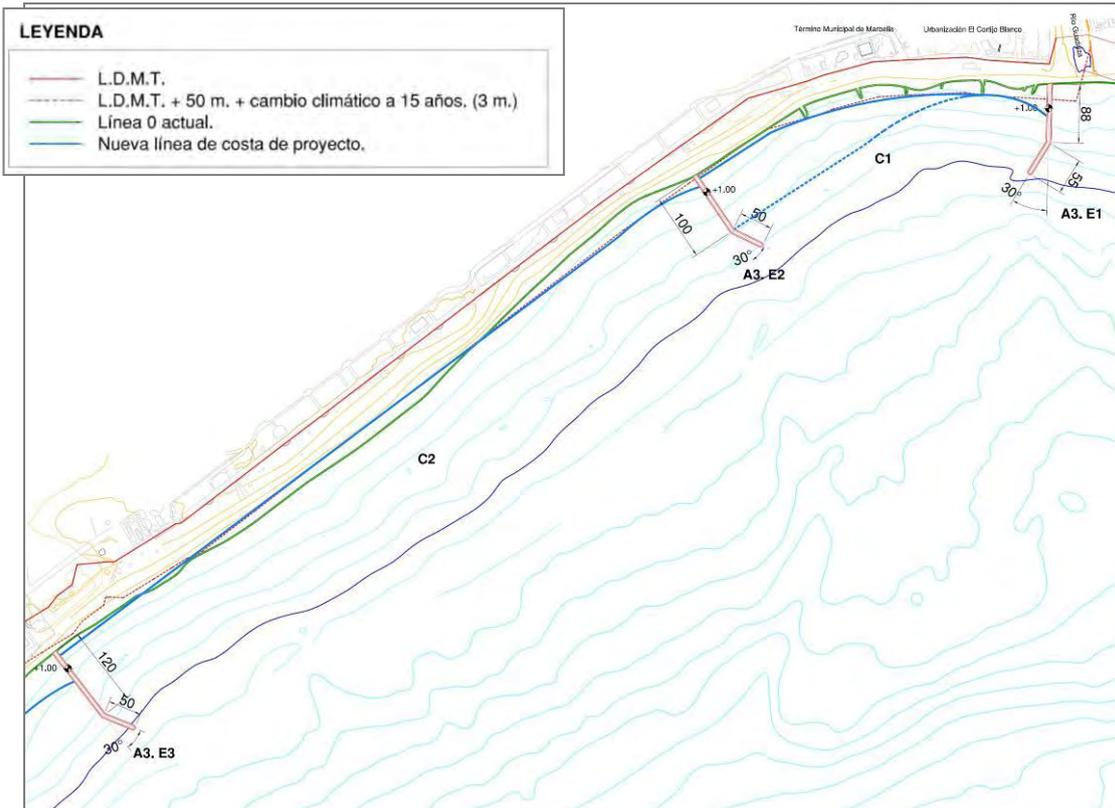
Planta Alternativa 3. Celdas C1-C2.
